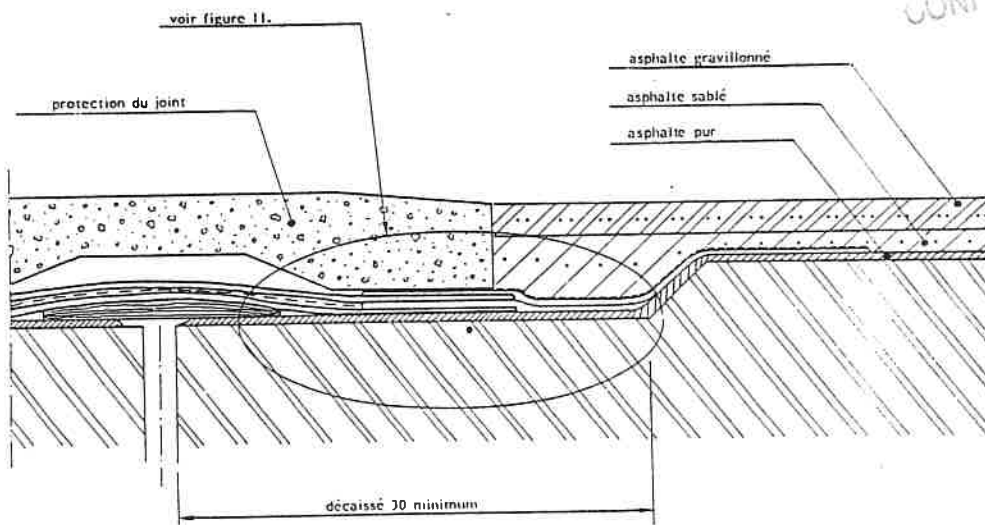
Raccordement à un revêtement asphalté - toitures accessibles aux piétons et aux véhicules (type 5 + 15 + 20)
